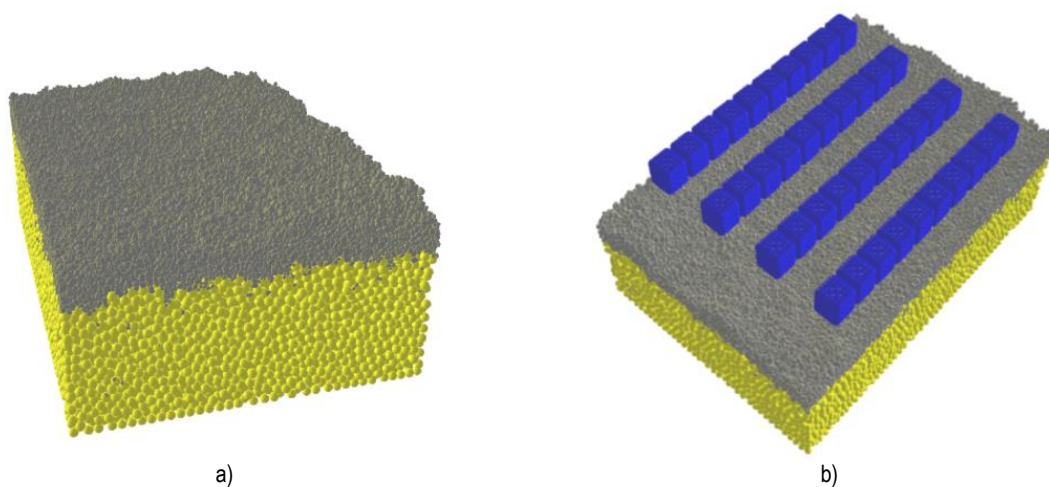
Modelação de um trecho de via-férrea por DEM: a) fundação e camada de balastro; b) fundação, camada de balastro e 4 travessas (Fortunato; *et al.*; 2020)
